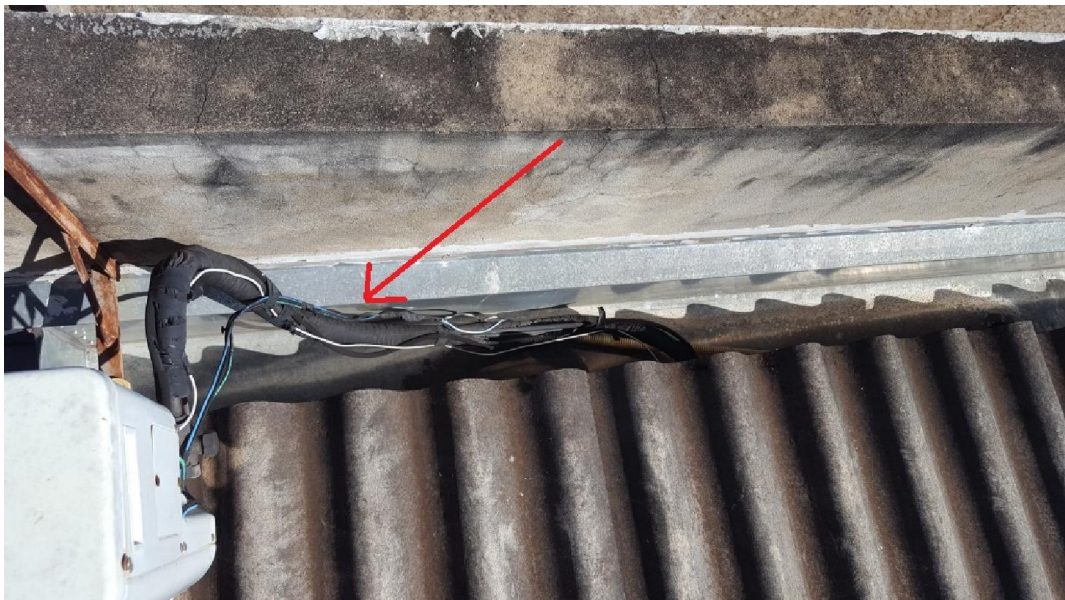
(Cobertura) – Fiação dos aparelhos condensadores desprotegidos. Solução: Encapar os fios expostos.
